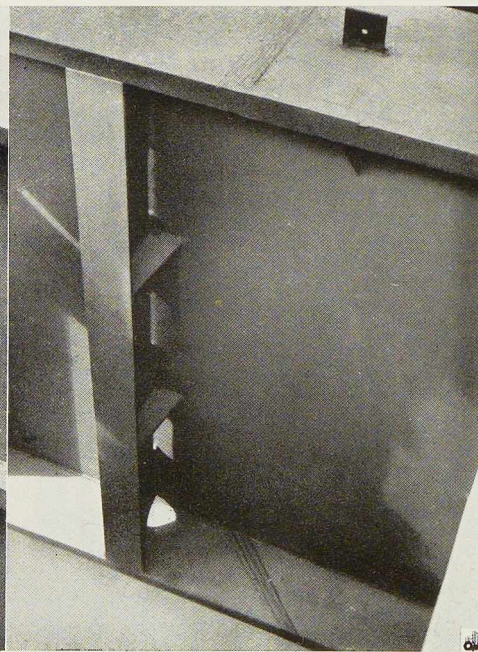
Entre les cadres du contreventement on a placé des raidisseurs en forme de T constitués par des tôles et des plats.
